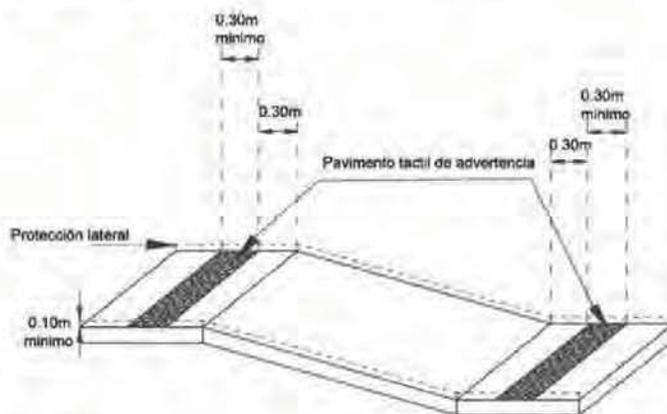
Rampa de pavimento táctil, perspectiva.
